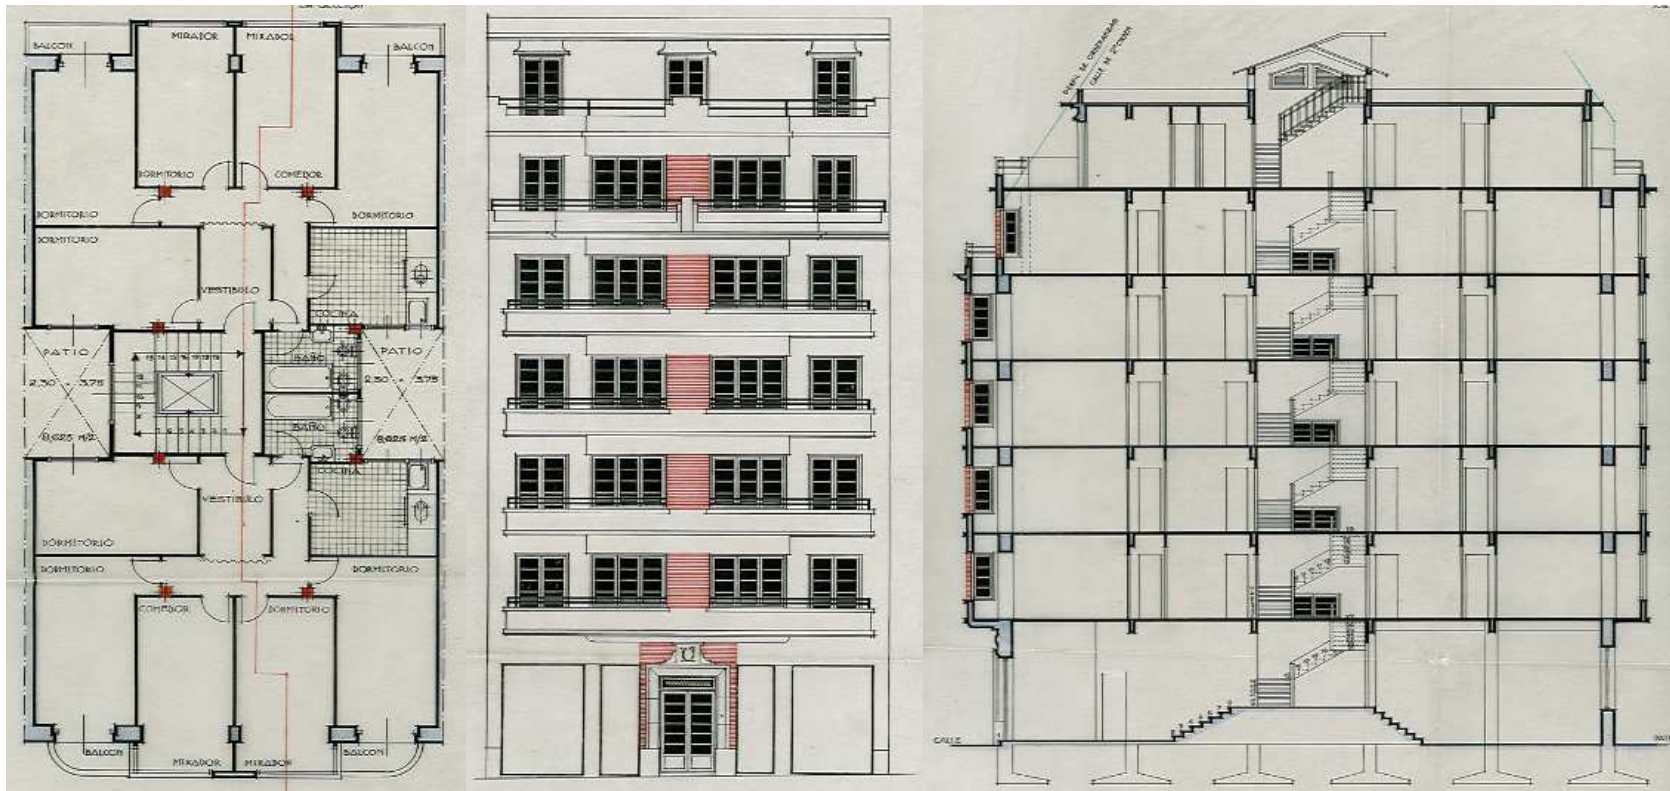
Plano de planta, alzado y sección del inmueble de Estilo Racionalista en la calle Segundo Ispizua nº 7.
